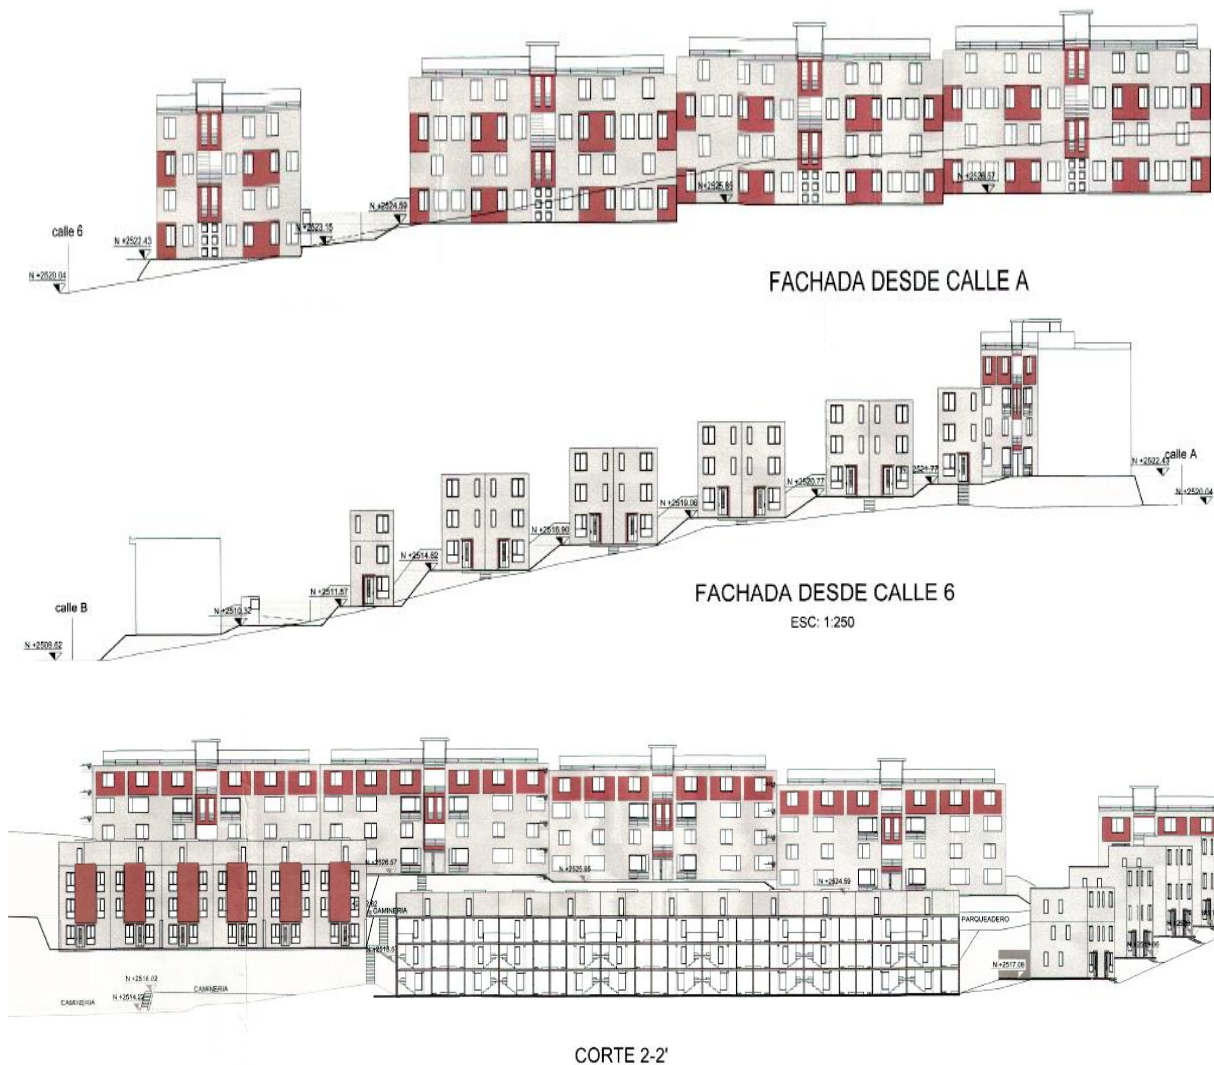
Fachadas y Cortes de Manzana N° 22
